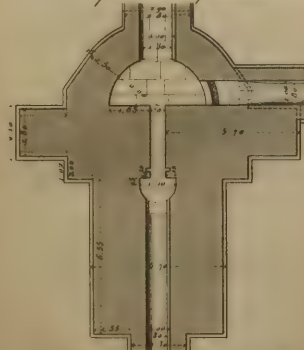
Plan supérieur de l'ouvrage de prise d'eau
